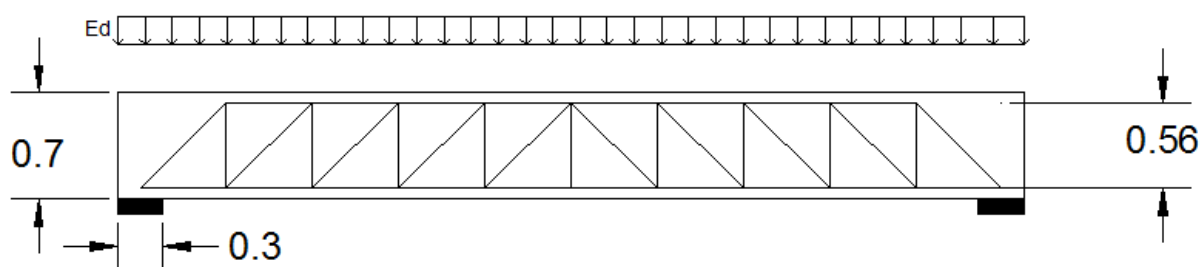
Modelo de escoras e tirantes adotado para a *Viga 3*.
